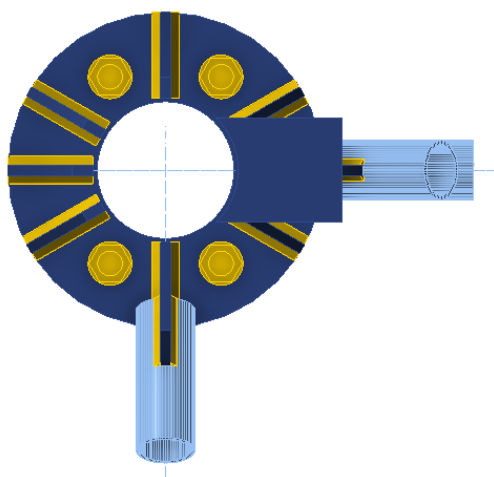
Розріз монтажного стыку верхнього поясу просторового блоку ферми
